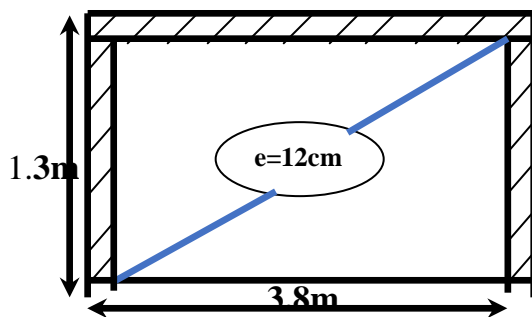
Balcons Type 1 (dalle appuyée sur trois cotés)
